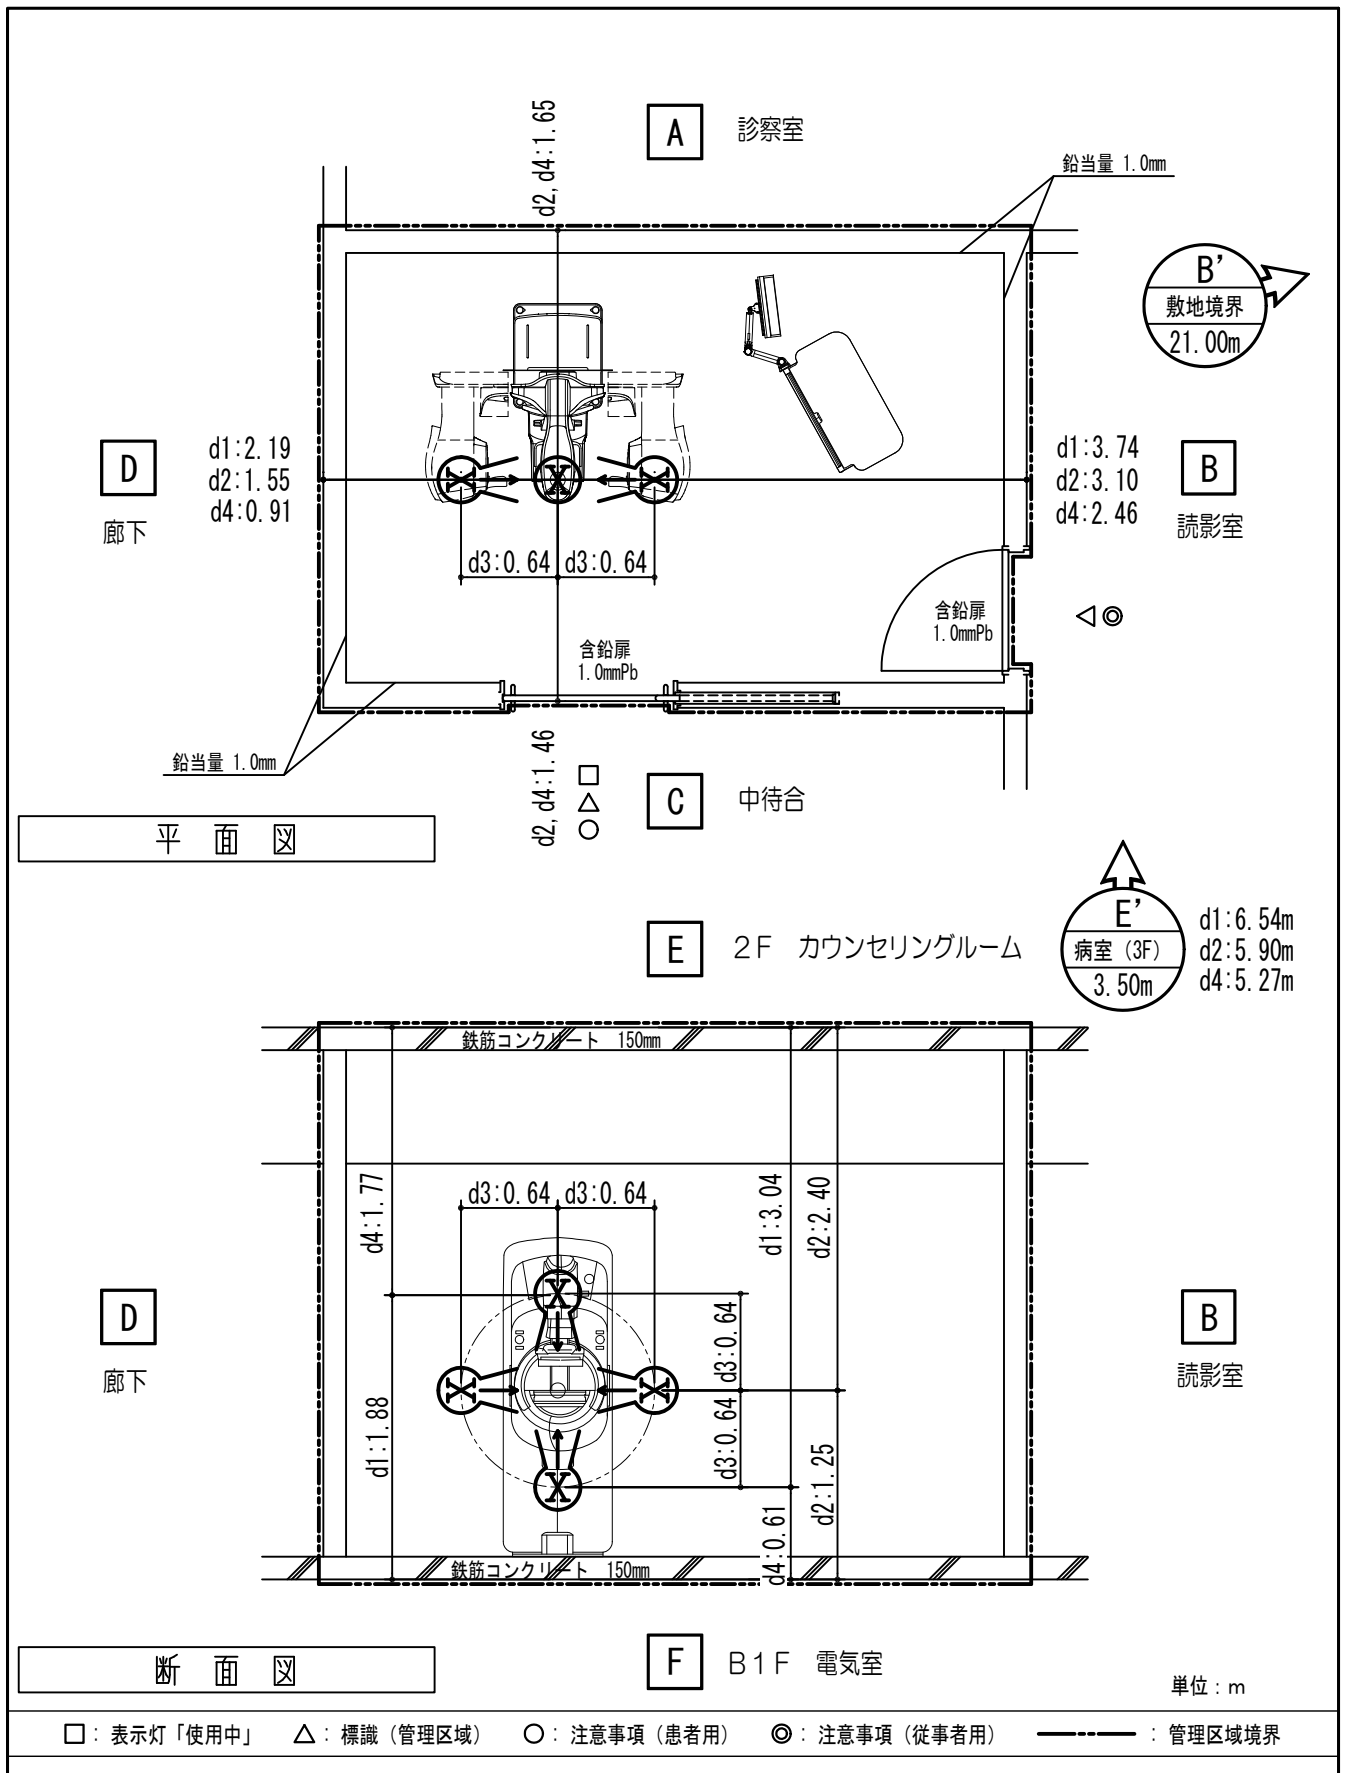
乳房用X線診断装置 乳房撮影 平面図・断面図
